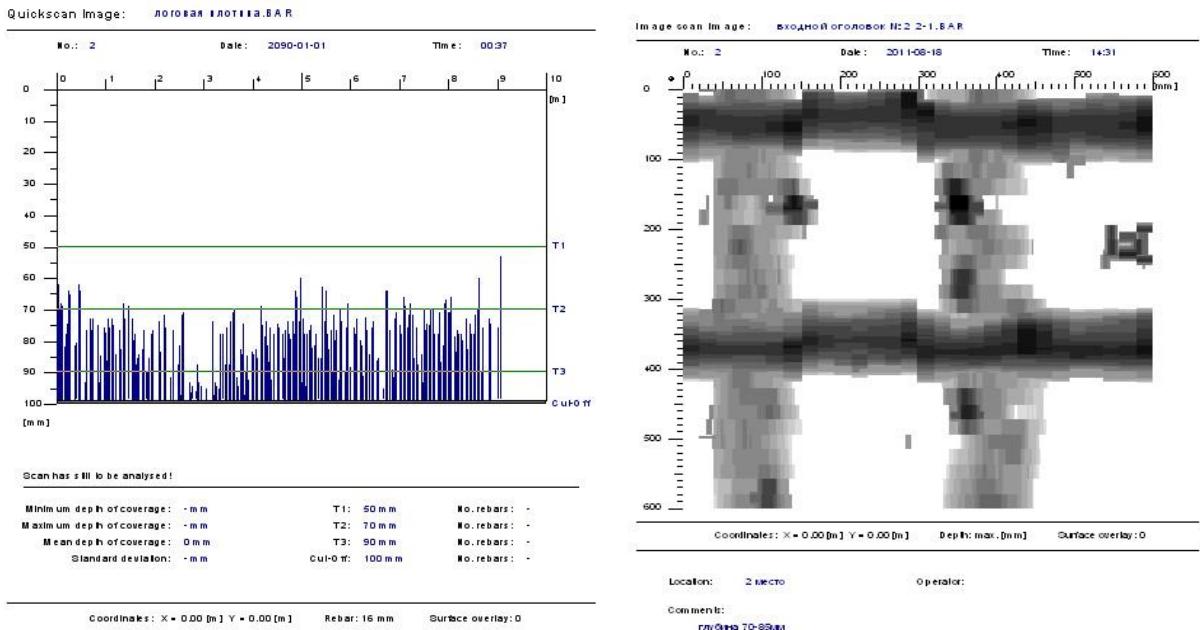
Данные обнаружения и распознавания арматуры в железобетонной конструкции.
